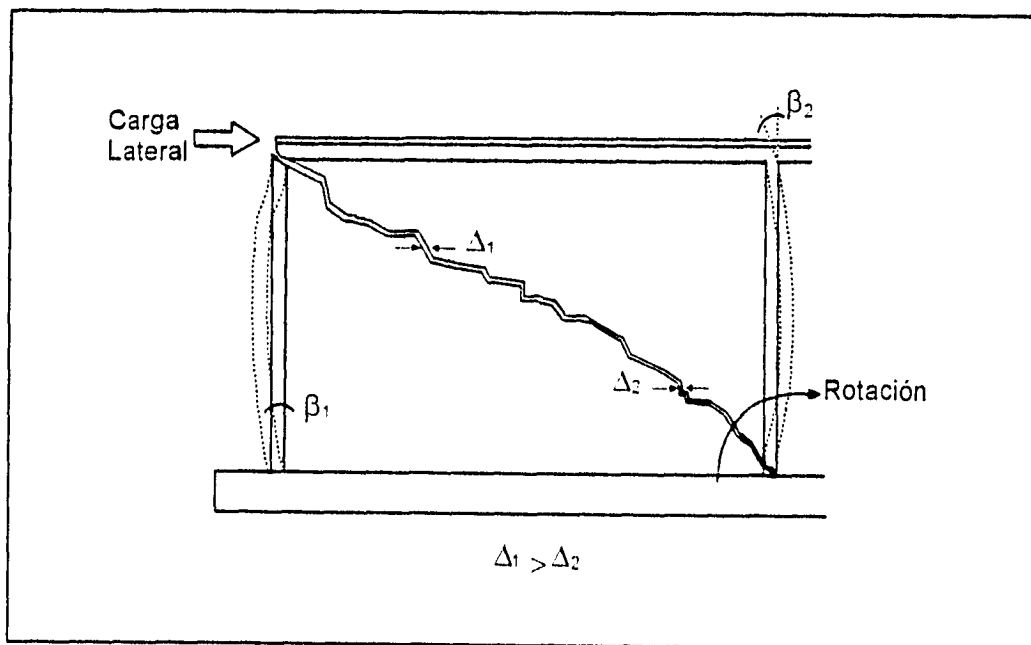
Deslizamiento y Giro de Bloques de Mampostería
